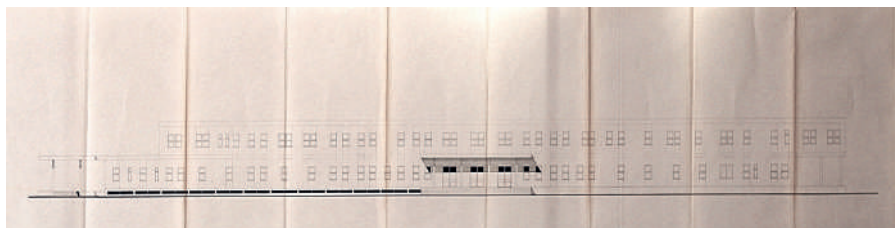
Raffaele Argo, Progetto di completamento e ristrutturazione dell’Ospedale, 2° lotto. Monoblocco A. Prospetto nord, scala 1:100, 20 marzo 1972 [da AOAPPCNa].
